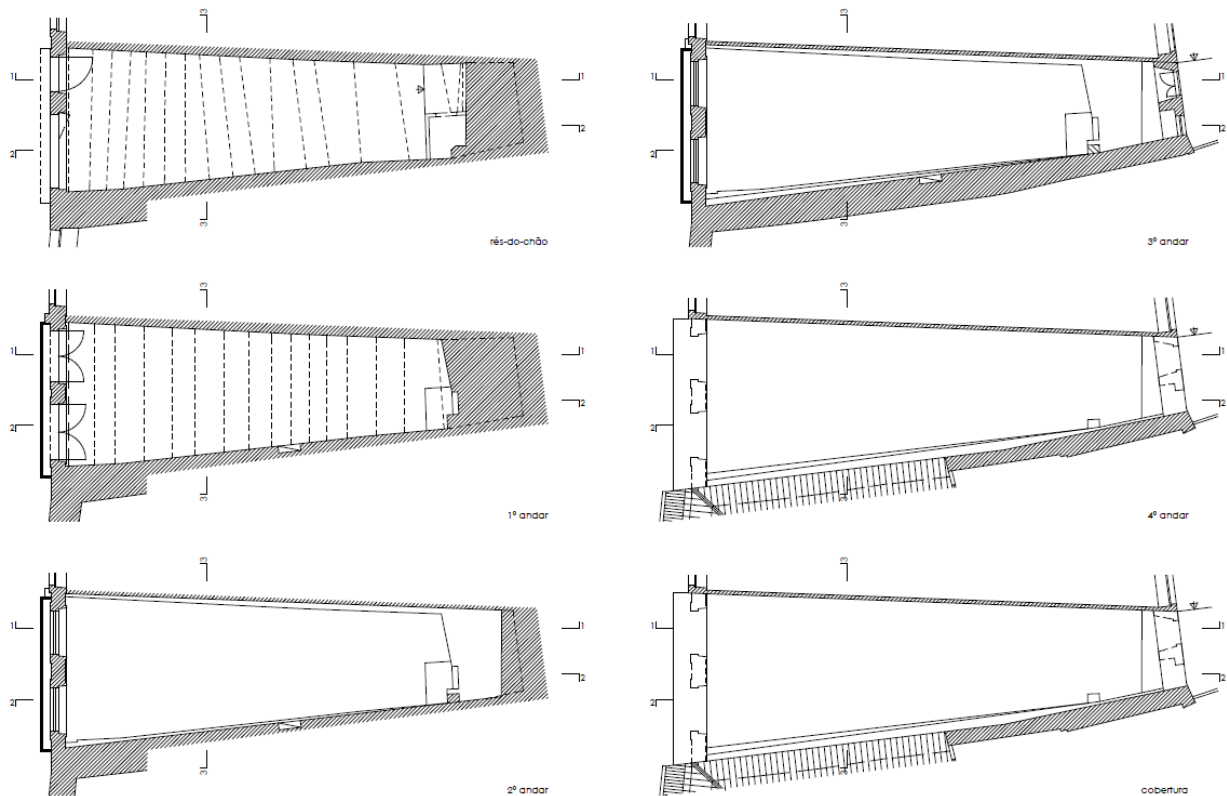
Plantas do existente antes da reabilitação [19]
